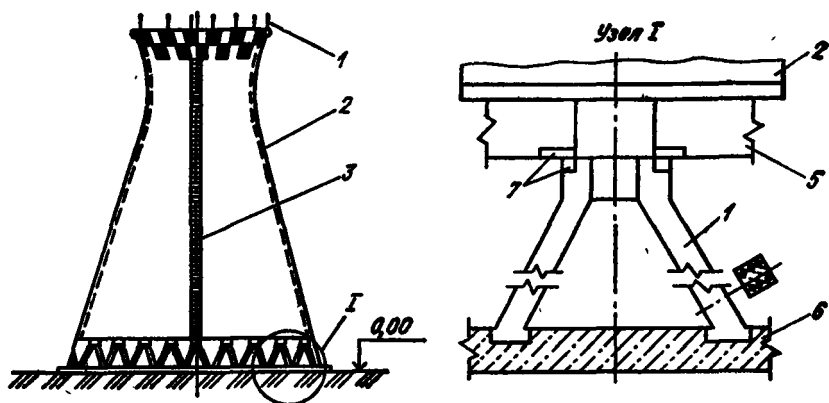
Общий вид гиперболической вытяжной башни и опорная конструкция: 1 — молниезащита; 2 — тело башни; 3 — лестница обслуживания; 4 — опора; 5 — верхний силовой пояс; 6 — фундамент; 7 — закладные детали
